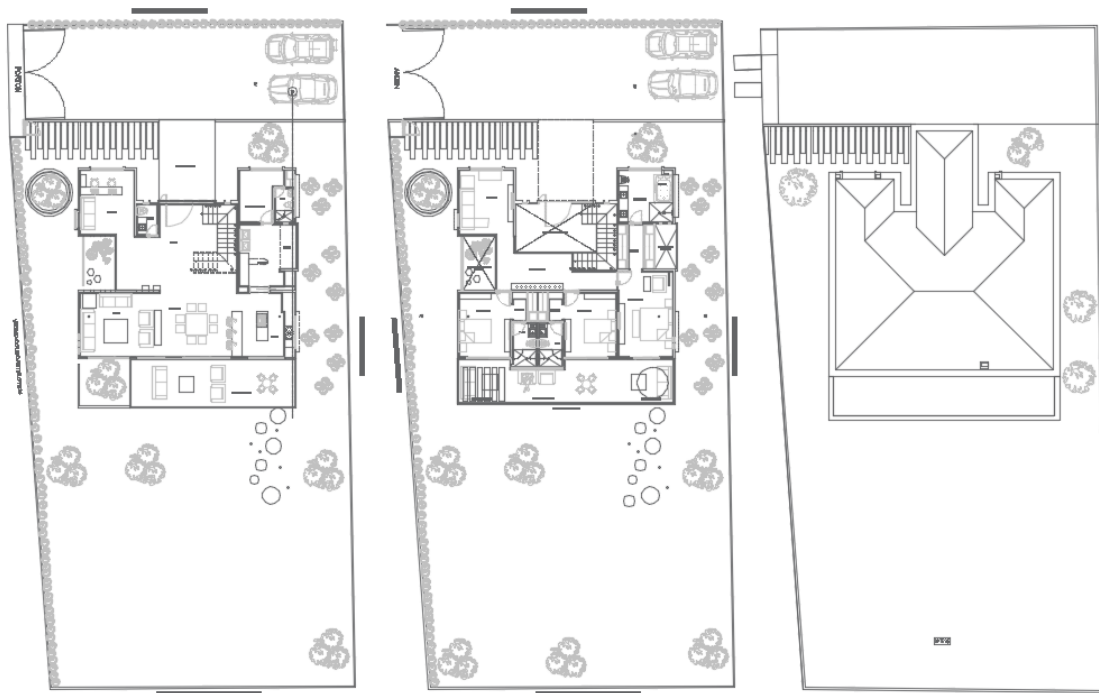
Planos en planta proyecto localizado en el lote no. 25, en el municipio de Piedecuesta.
